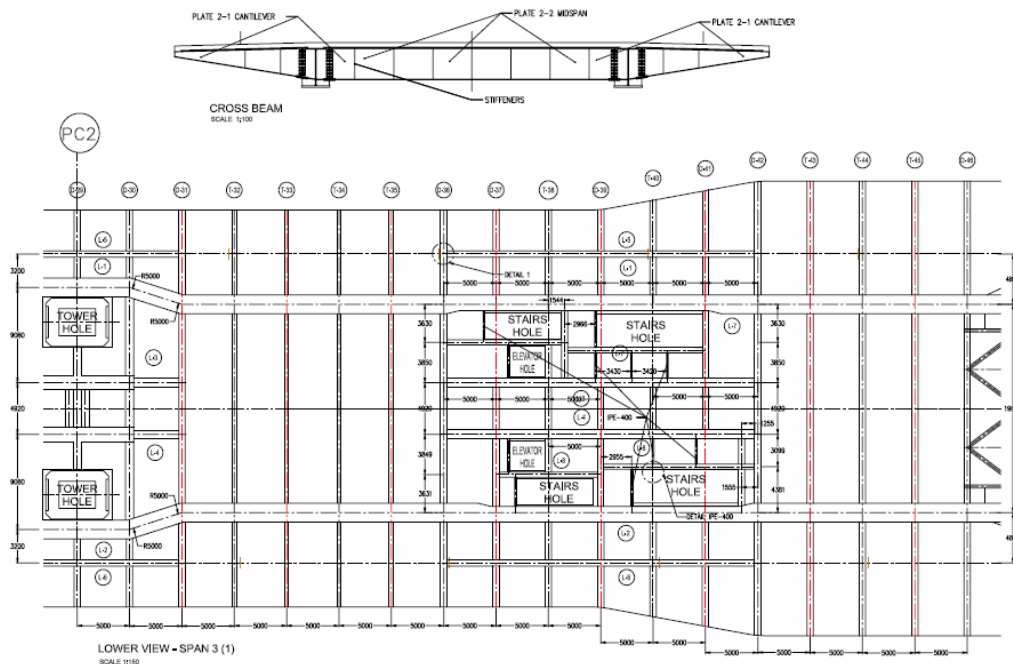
Planta de vigas metálicas en zona de torres y escaleras
